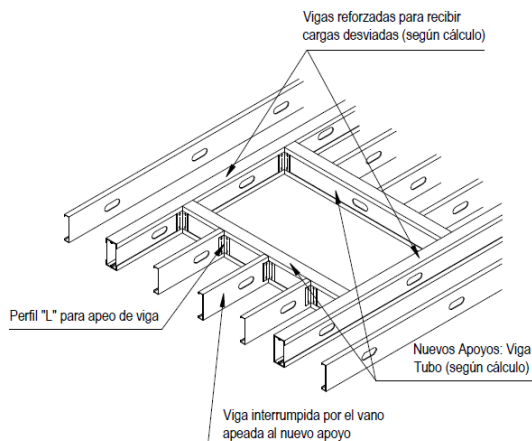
Ejemplo de estructura en aberturas. (ConsulSteel, 2002).
